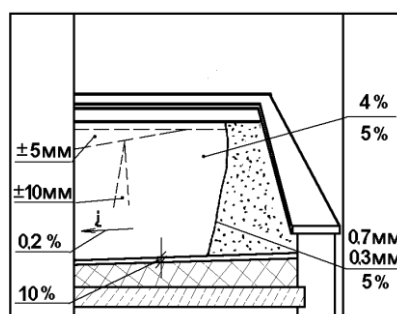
Схема допускаемых отклонений при приемке покрытия кровли
